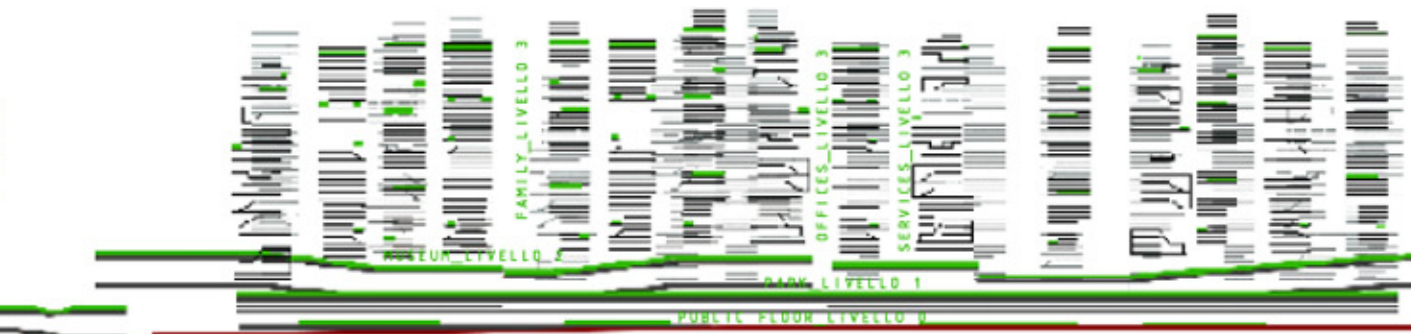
SEZIONE VERTICALE DEL COMPLESSO. A SINISTRA: SEZIONE VERTICALE DEL COMPLESSO. A DESTRA: SEZIONE VERTICALE DEL COMPLESSO.
